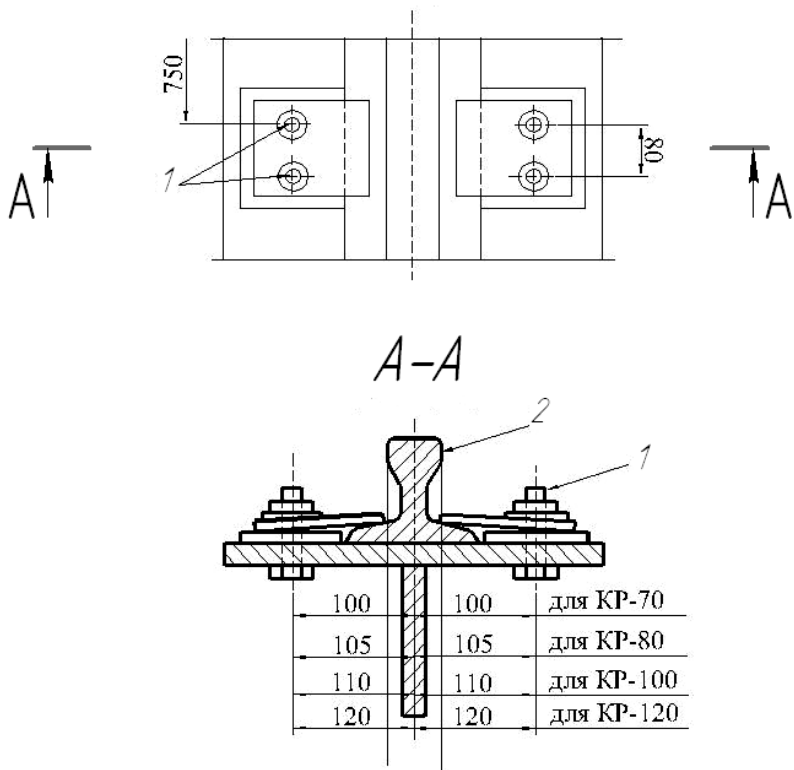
Схема крепления кранового рельса к поясу подкрановой балки:
